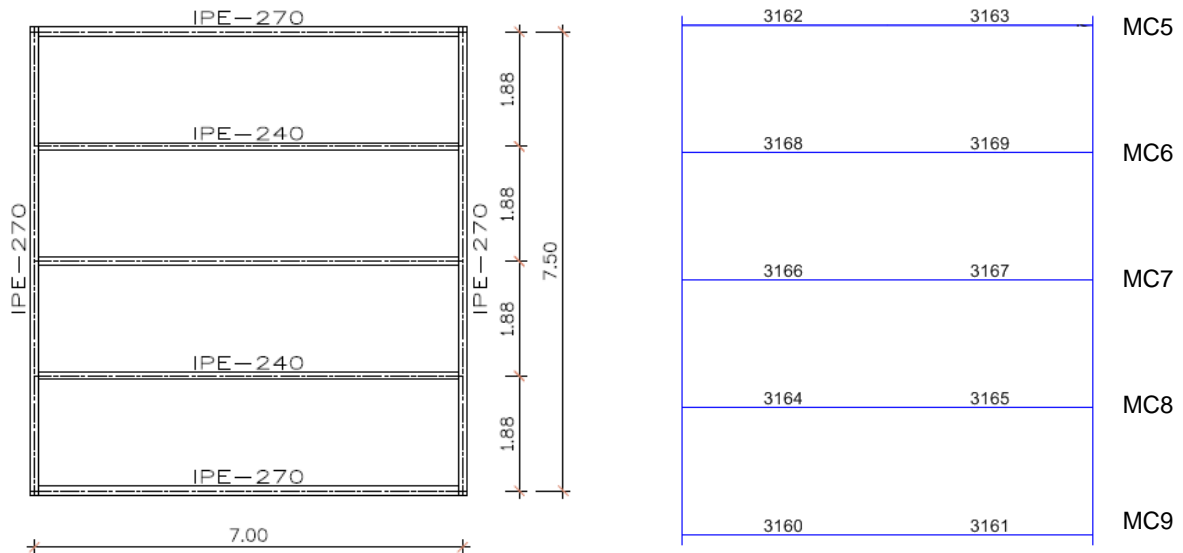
Planta com a Geometria e Identificação das Vigas da Cobertura 2.
